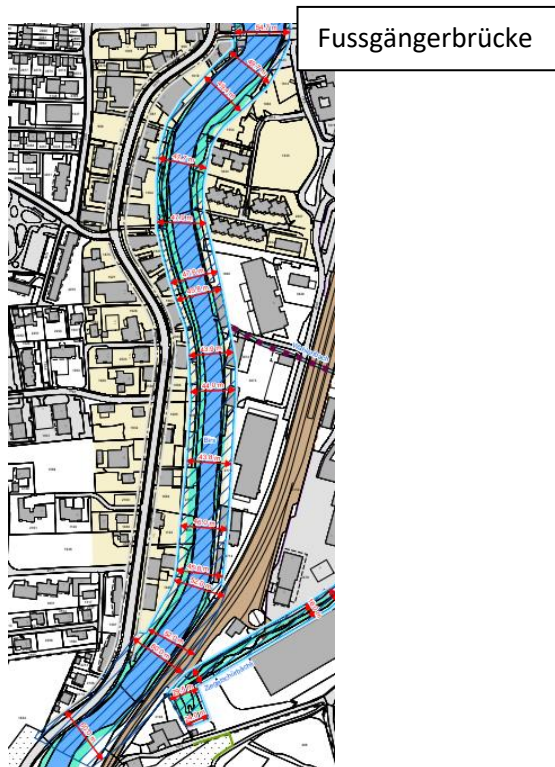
Planausschnitt "Laufen Süd" (Quelle: Mutationsplan 1:1'000)
